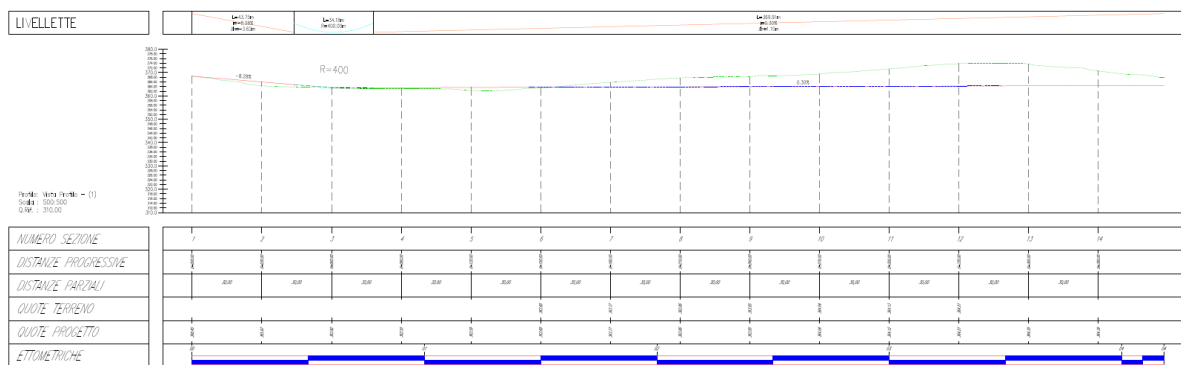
Profilo longitudinale tratto di viabilità di nuova realizzazione. Fonte: elaborato di progetto “GRE.EEC.D.73.IT.W.15235.12.015.00_Layout strade WTG5-WTG10”
